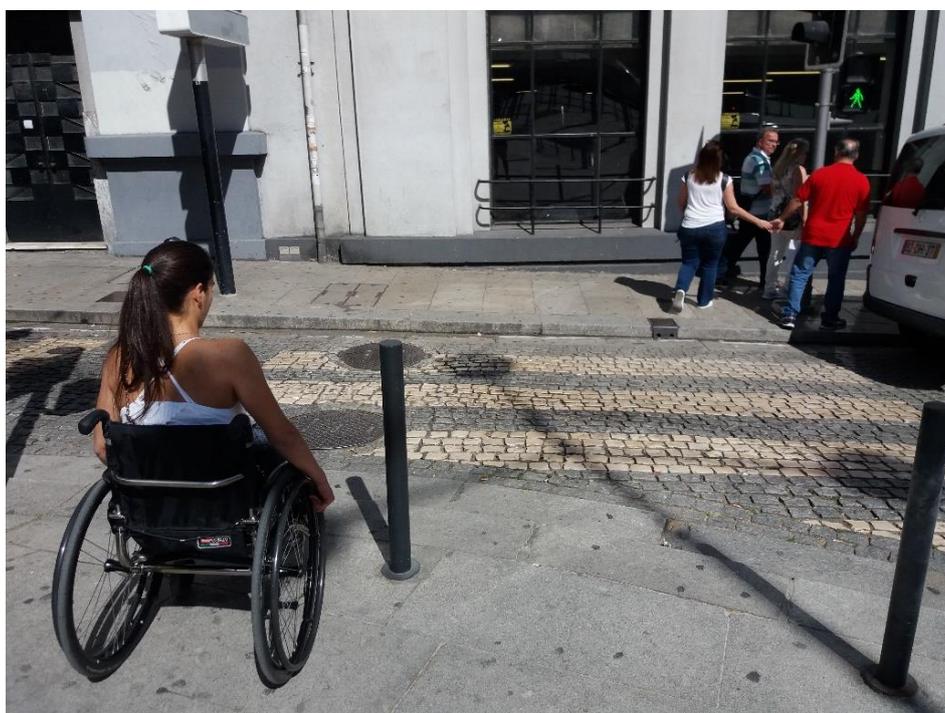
Passadeira com rebaixamento de um lado e sem rebaixamento do outro
